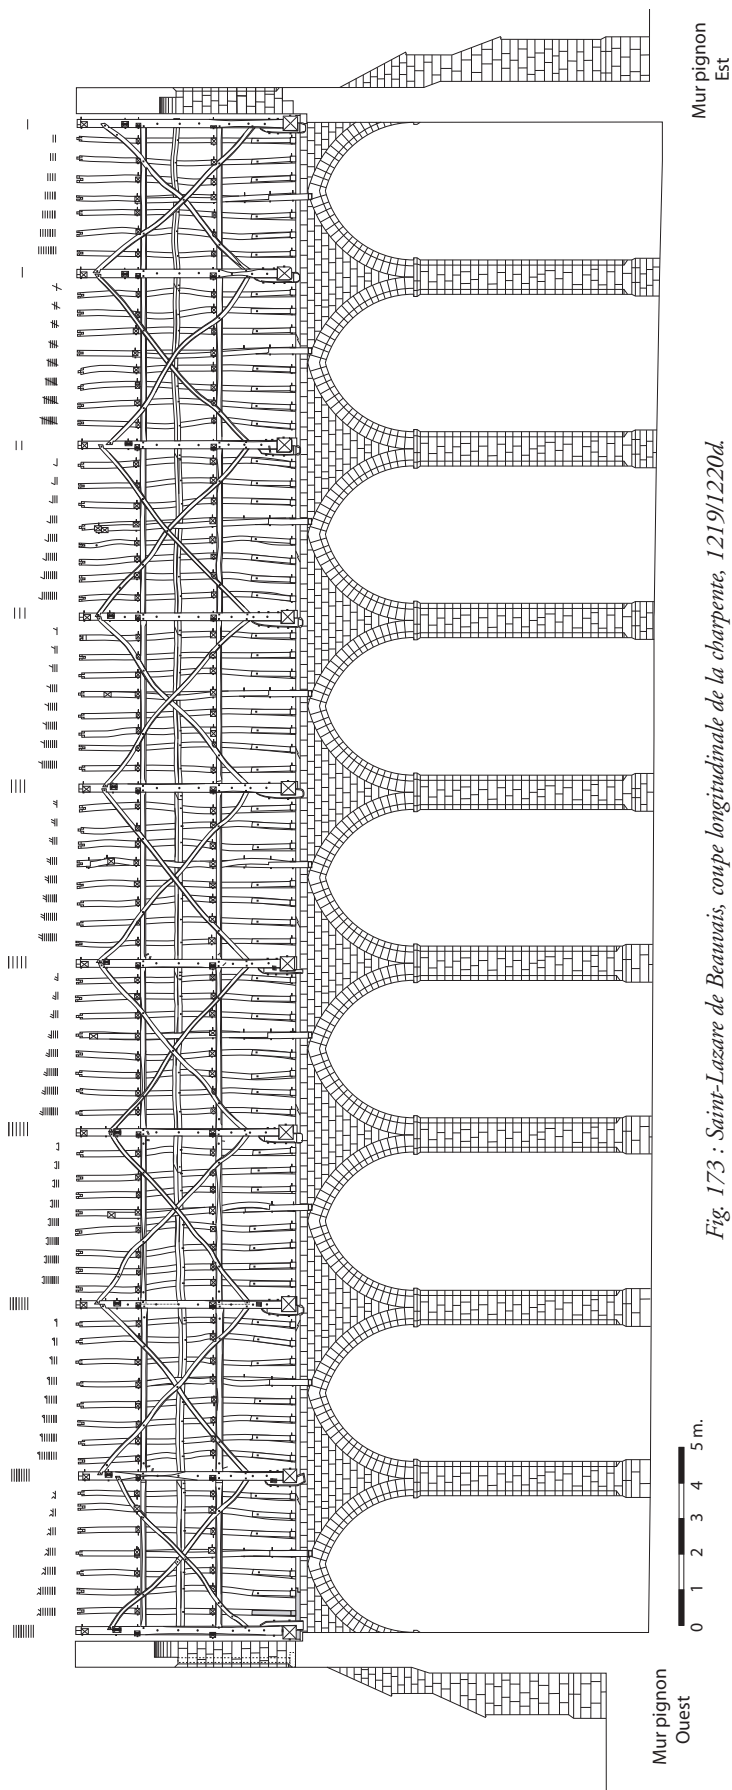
Saint-Lazare de Beauvais, coupe longitudinale de la charpente, 1219/1220d.
